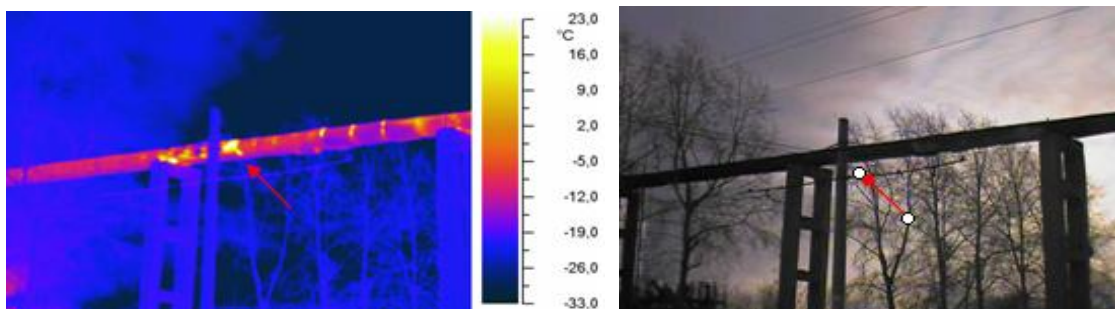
Нарушение теплоизоляции теплотрассы
